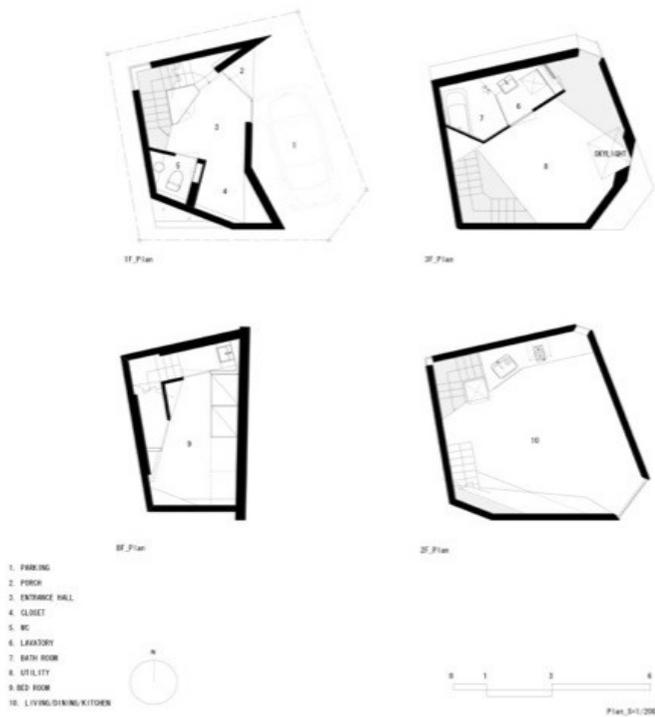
Grundrisse, Reflection of Mineral
